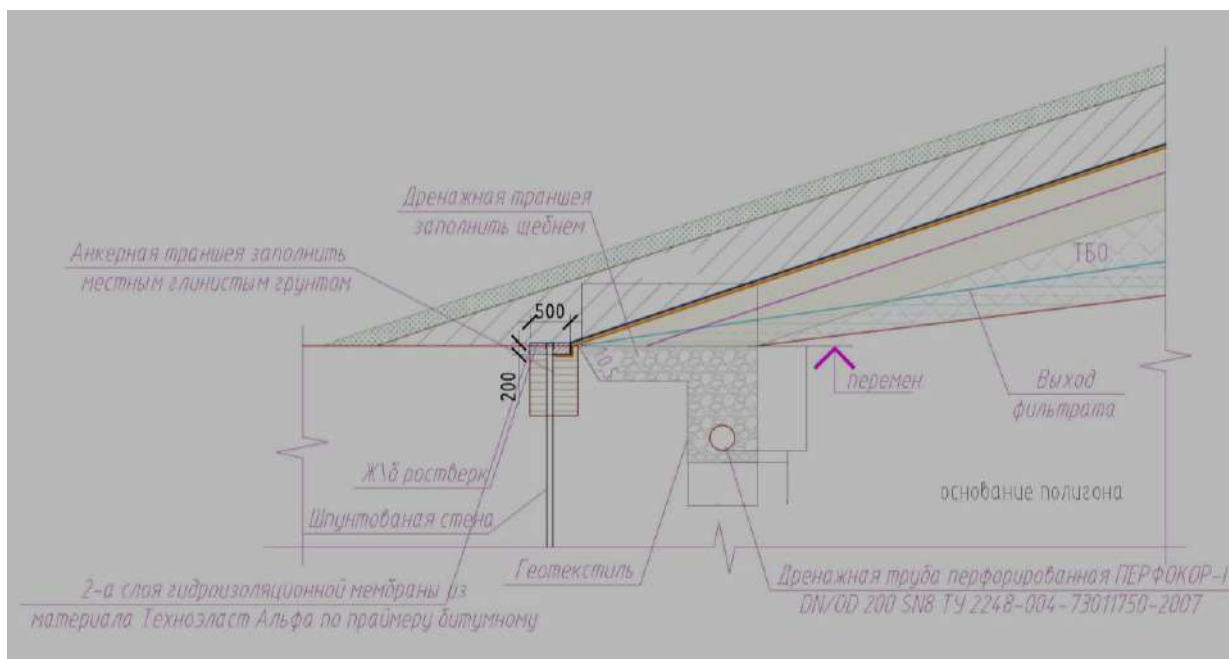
Конструкция шпунтованной стены и ростверка, анкерной траншеи.
